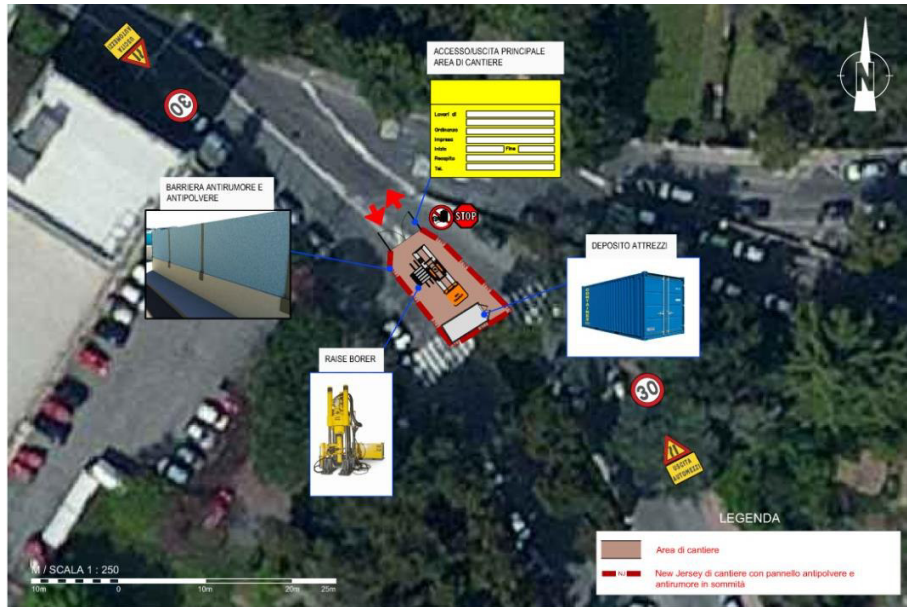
Planimetria cantiere aeroporto giardini via Ricci
